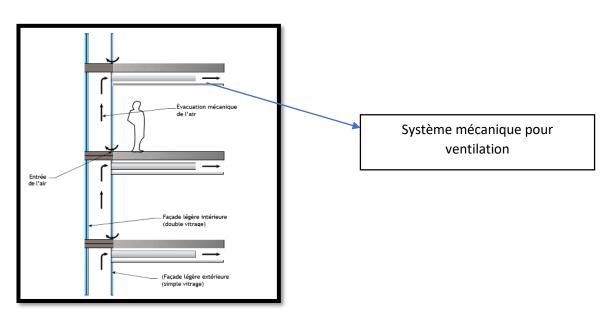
détail façade double peau ventilée sur l'extérieur mécaniquement
